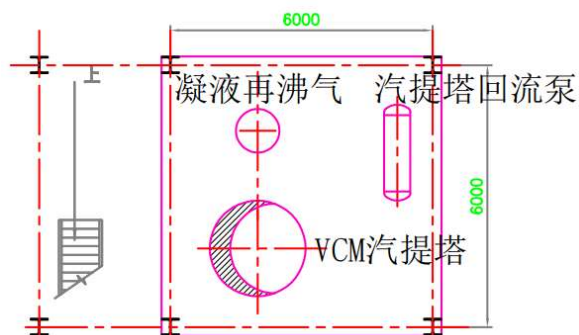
VCM 汽提塔局部平面布置图（一、二期布局相同）
